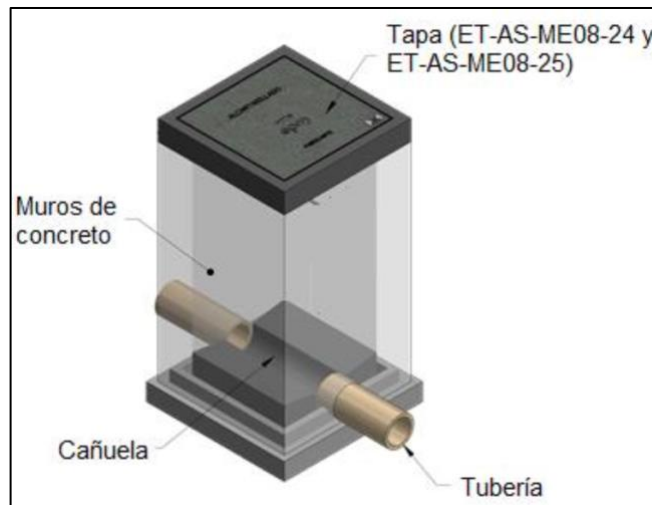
Caja de inspección. Fuente. EPM, 2019
